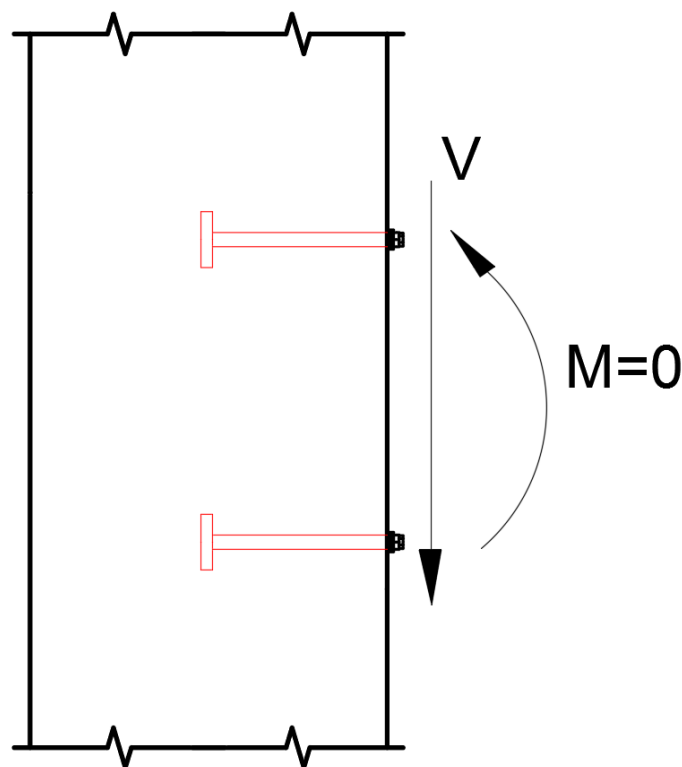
Esfuerzos del mecanismo en la junta pilar-viga
